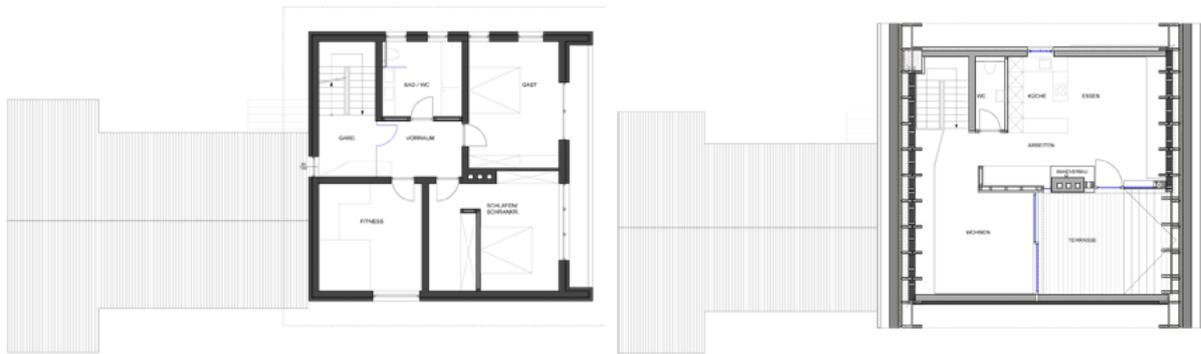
Grundrisse des Dachausbaus
